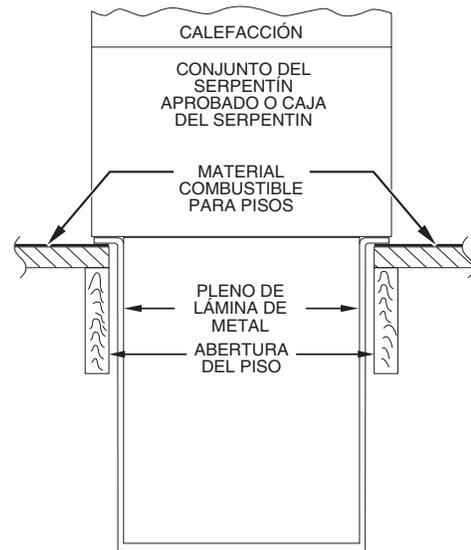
Conjunto de calefactor, cámara y serpentín o caja de serpentín instalada en un piso combustible
